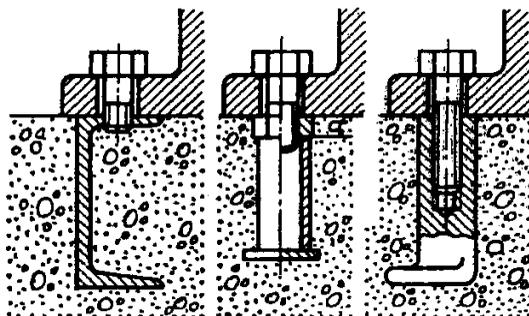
Фундаментные болты: а – заливной; б – фундаментный с шайбой;
